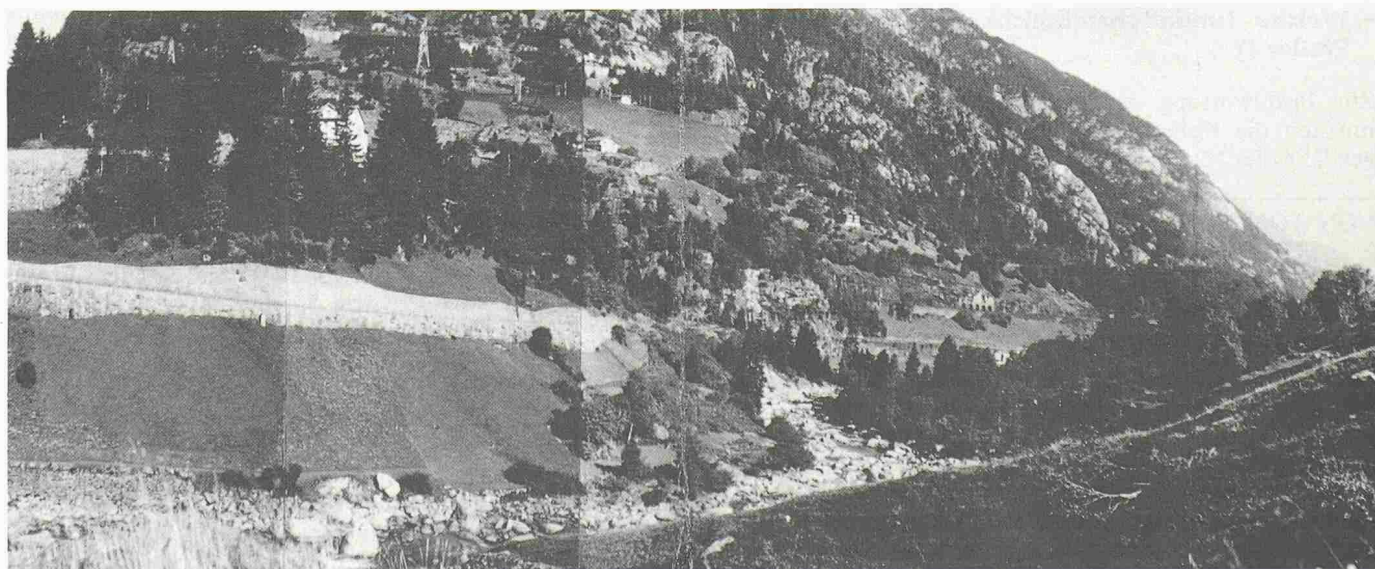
Reussbett vor dem Bau der Brücke (Blick talabwärts)
